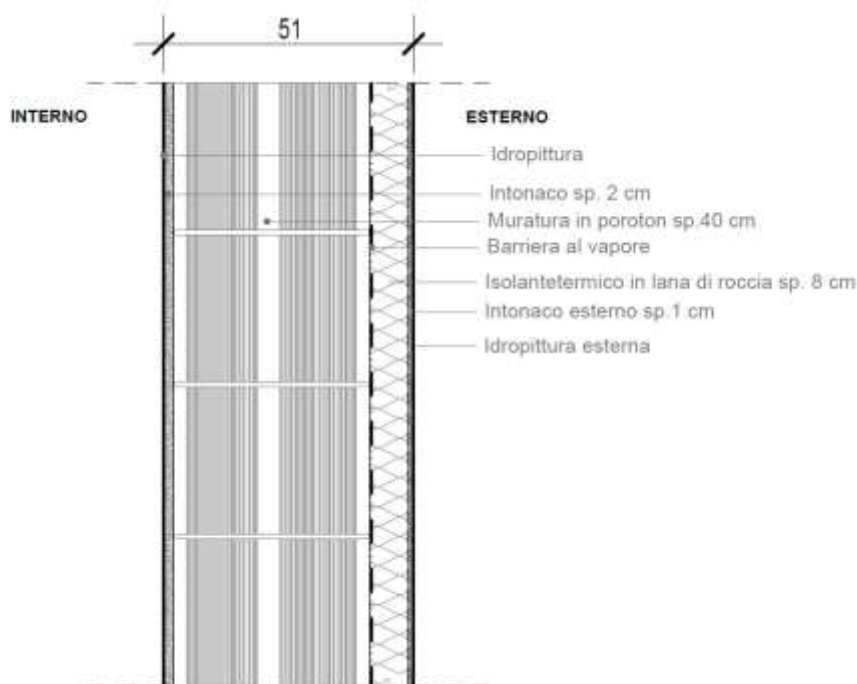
dettaglio della muratura realizzata con cappotto esterno
